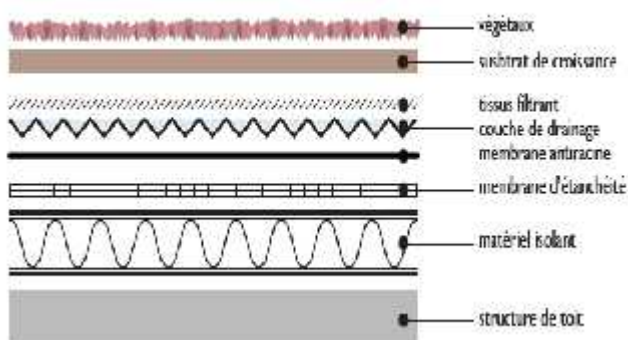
Vue en coupe d'un toit végétalisé extensif
